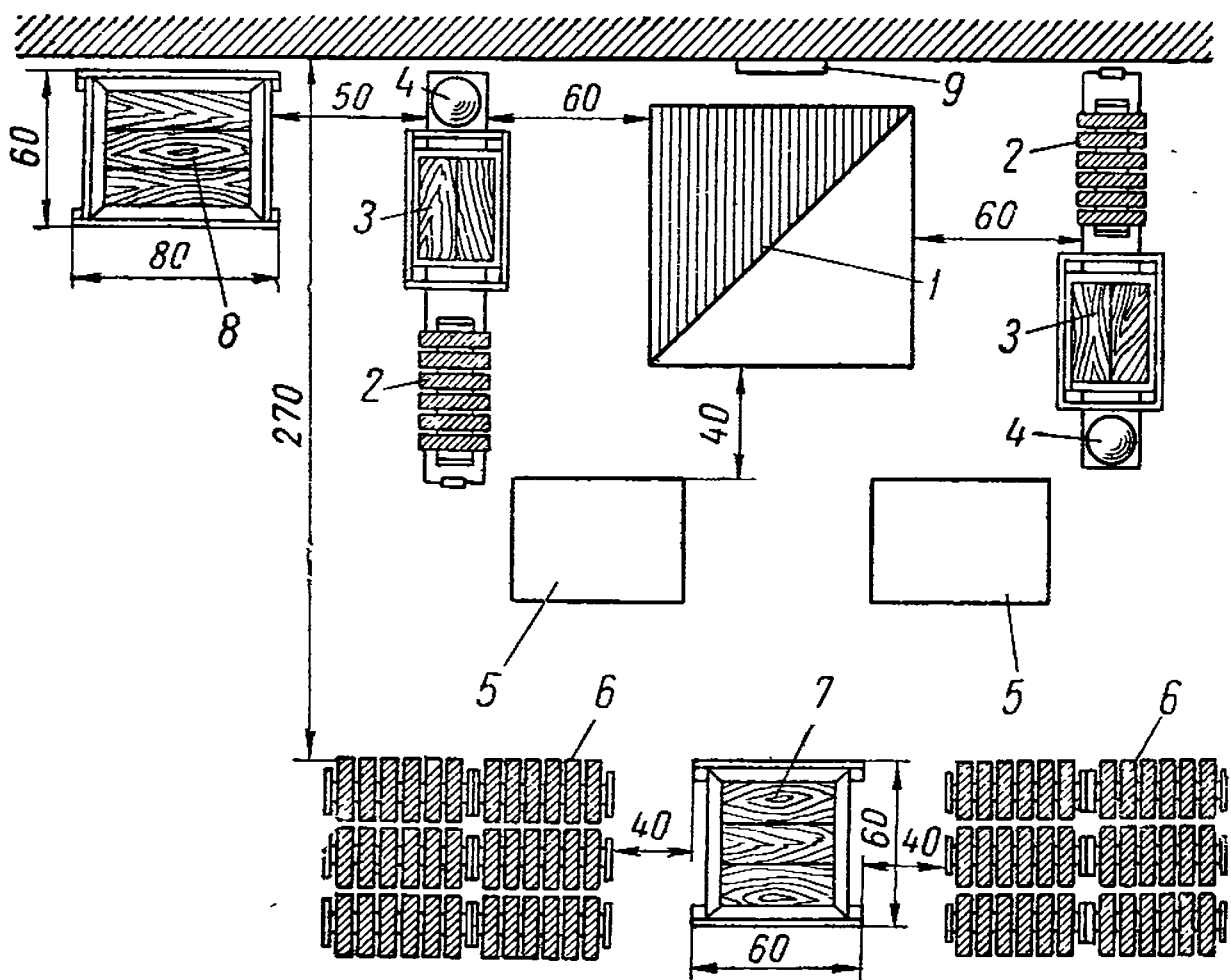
Схема организации рабочего места при кладке печи у стены:
